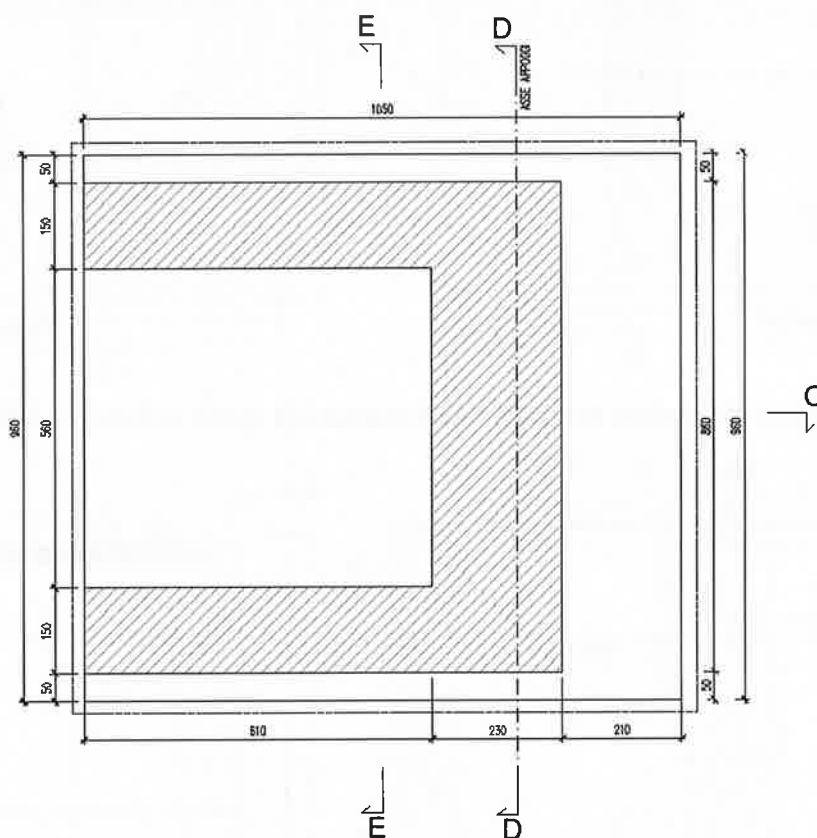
Pianta fondazione spalle A e B Bonorva VI01
